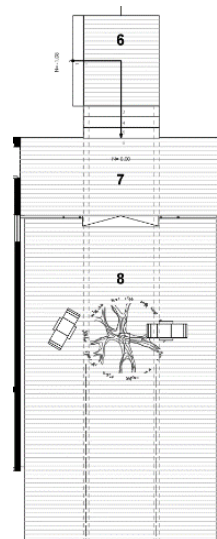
Planta baja, zonificación área central. Fuente: Autor.
